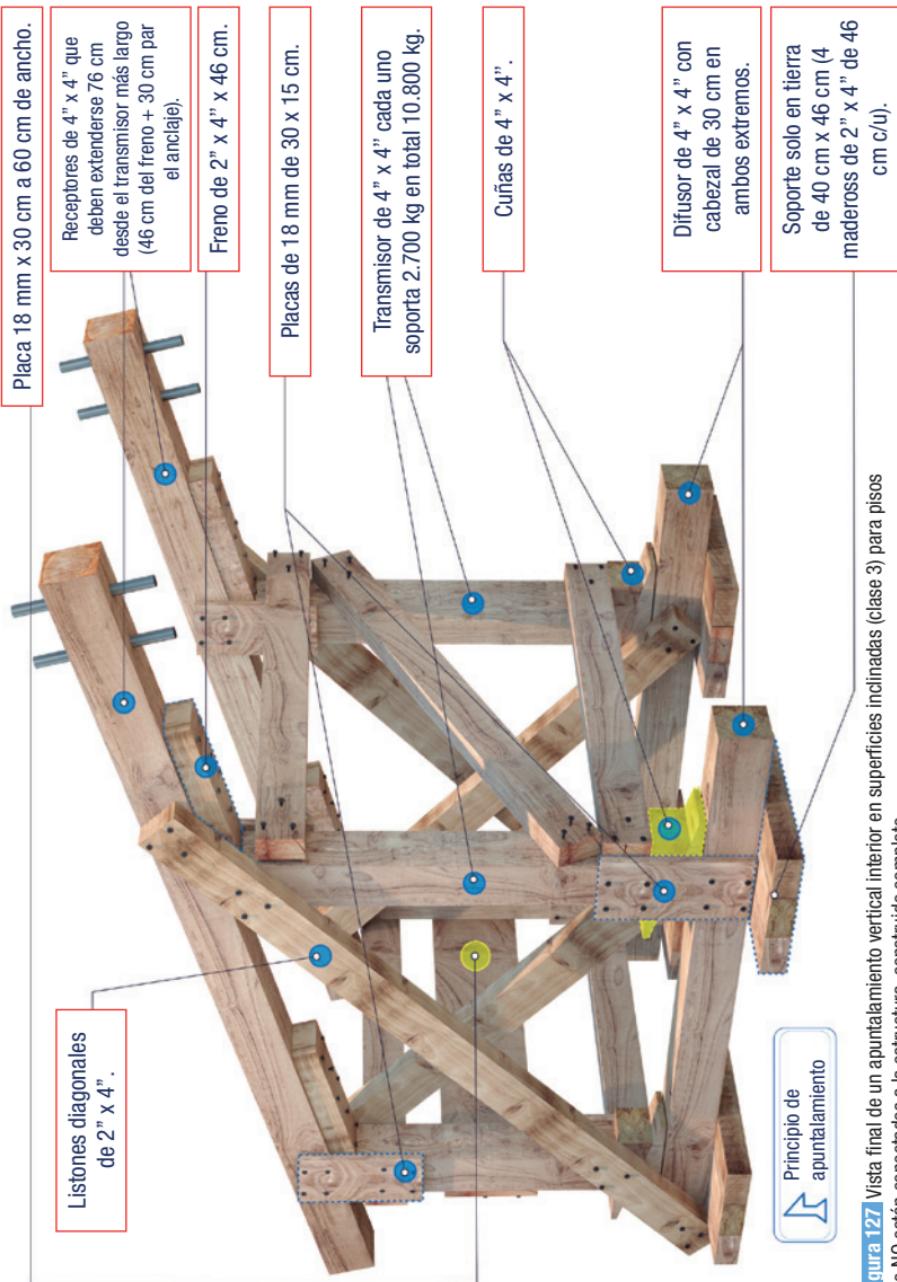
Vista final de un apuntalamiento vertical interior en superficies inclinadas (clase 3) para pisos que NO están conectados a la estructura, construido completo.
